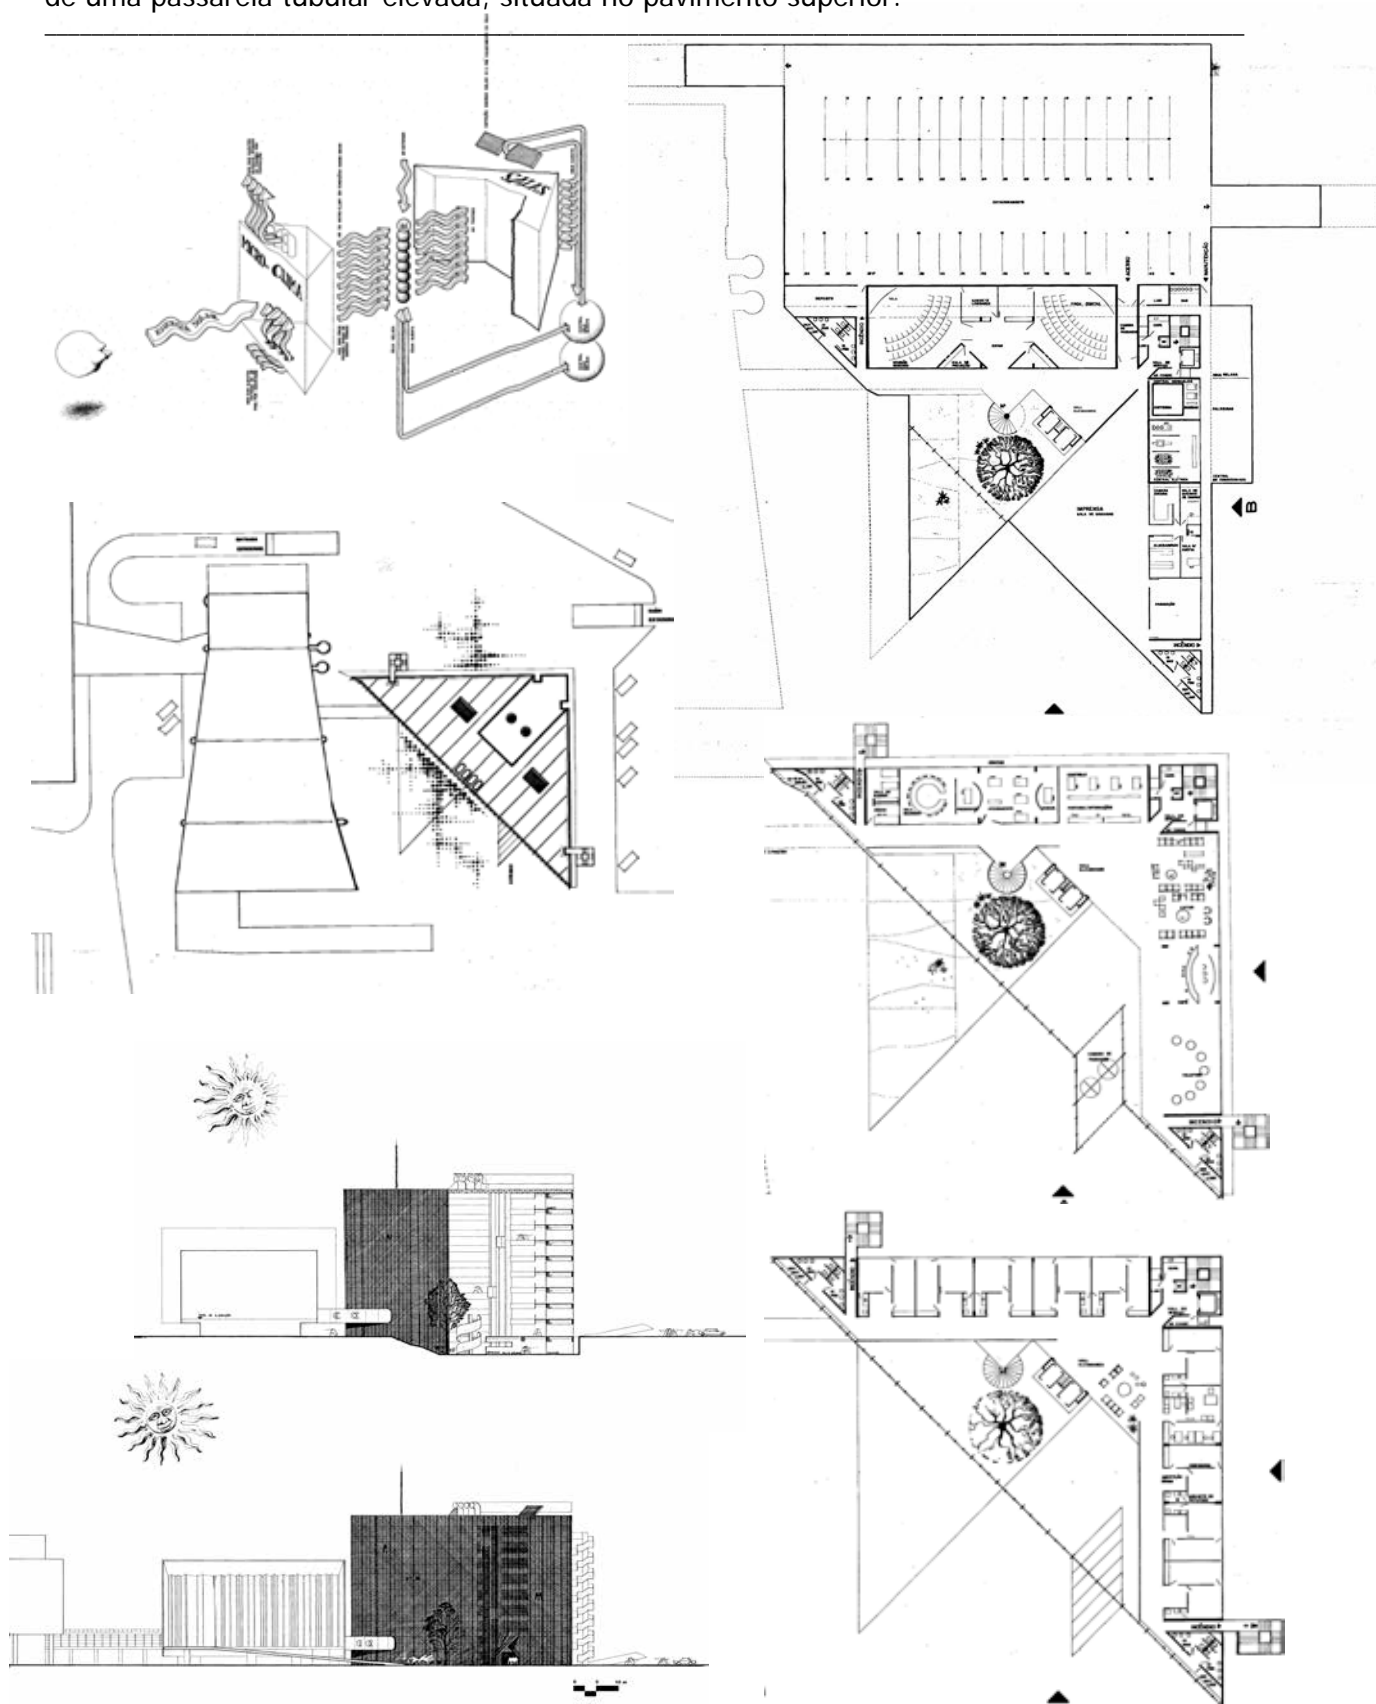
esquema representando funcionamento microclima; Fig. 844: (dir. sup.) planta subsolo; Fig. 845: (esq. inf.) implantação; Fig. 846: (dir. meio) planta pavim. térreo; Fig. 847: corte transversal; Fig. 848: (dir. inf.) planta pavimento tipo.
